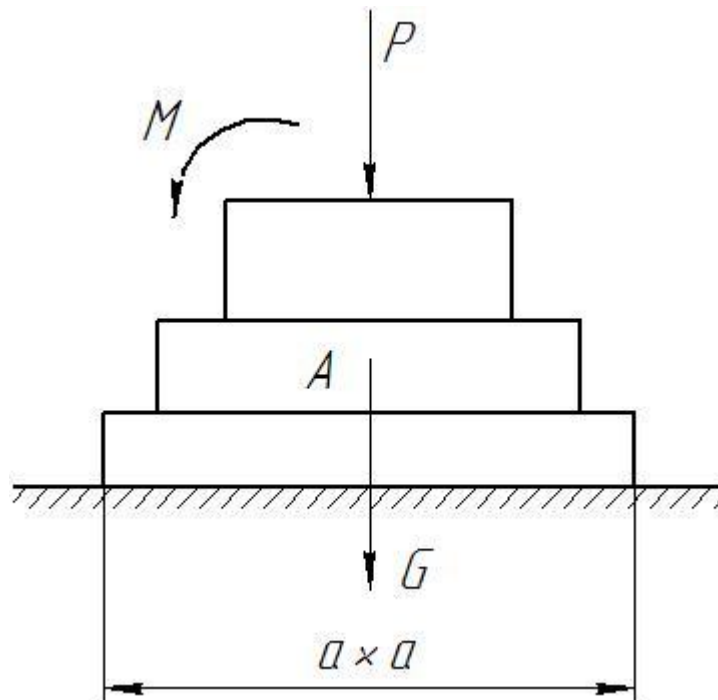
Розрахункова схема для визначення тиску фундаменту на ґрунт
